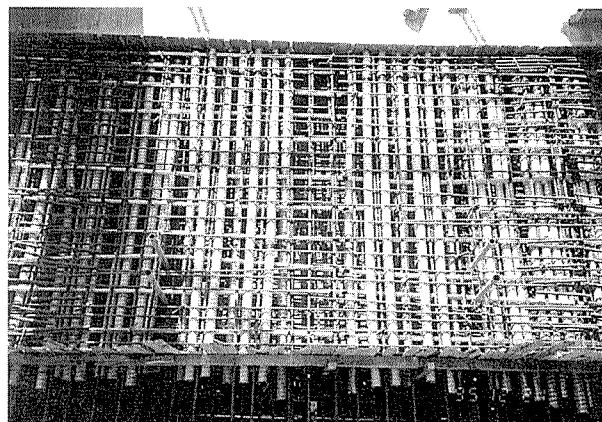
第2ブロック上床版の鉄筋・シース配置状況
